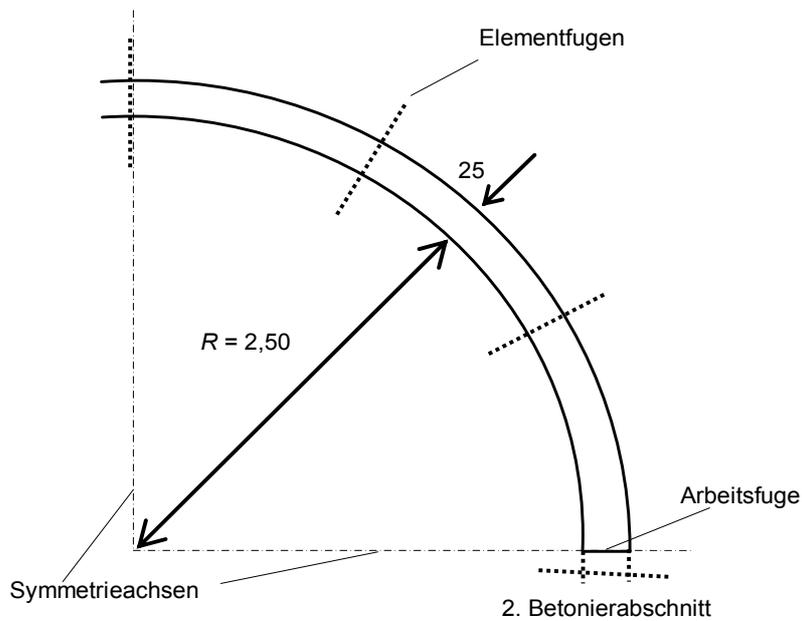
Teilgrundriss B: 1. Betonierabschnitt
